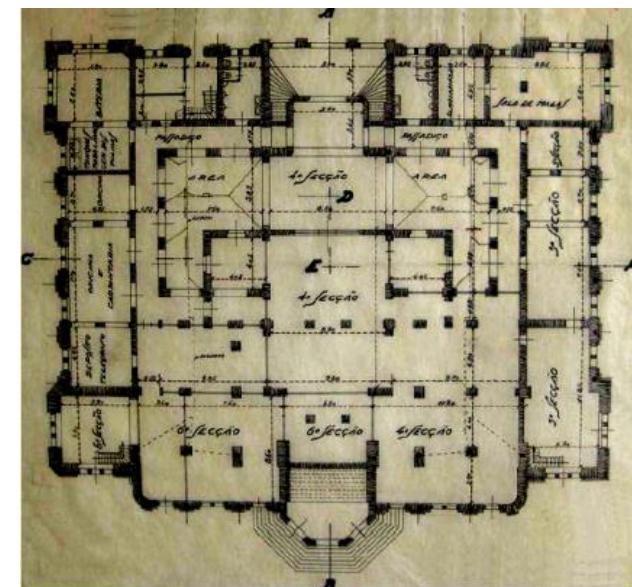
Planta 1º pavimento dos Correios e Telégrafos
